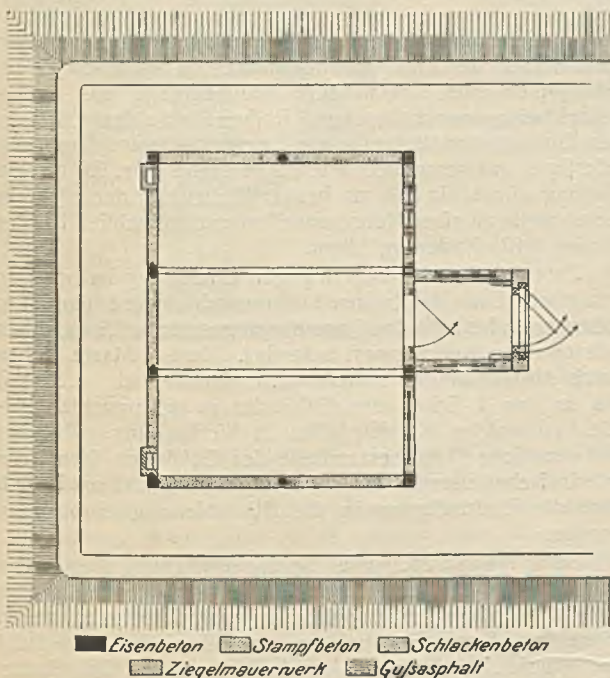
Grundriß des Sprengstofflagers in Pécs. M. 1:150.
